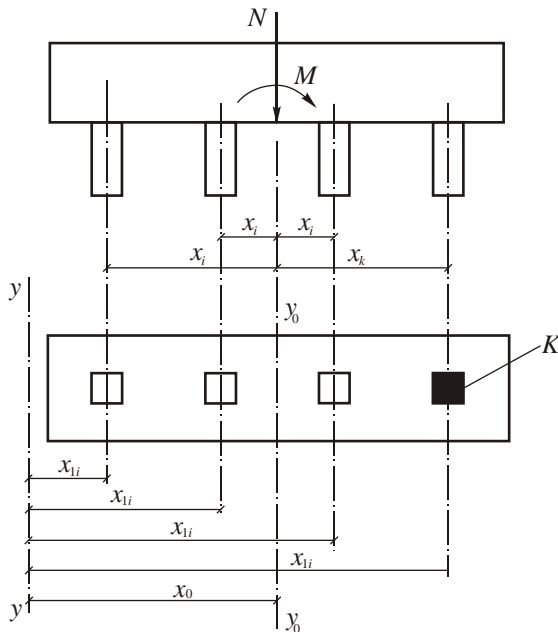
Схема к определению продольного усилия на сваю
